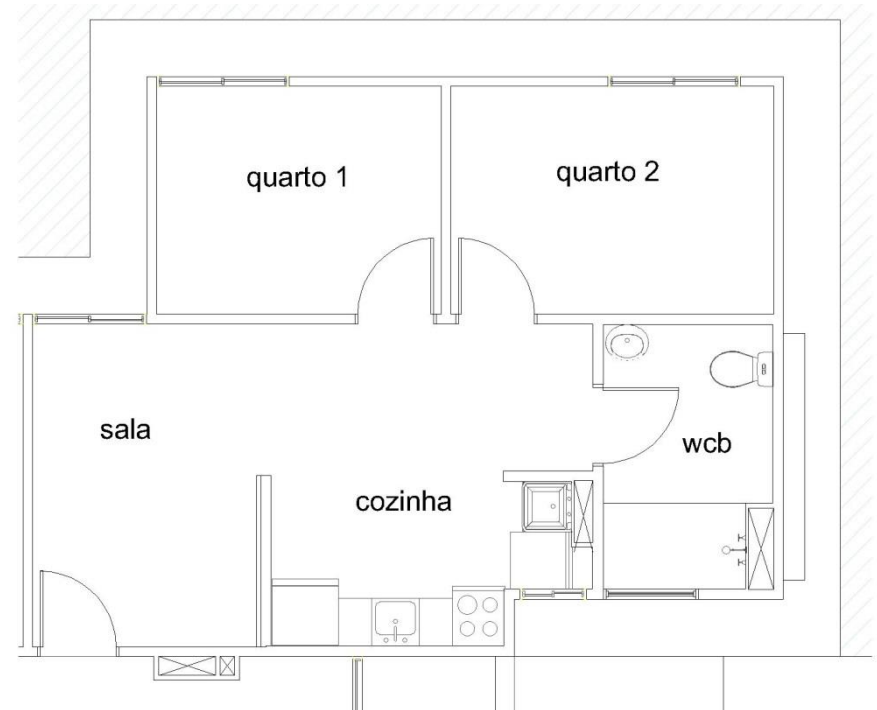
Planta baixa da Tipologia Arquitetônica do CH Colinas de Gramame
